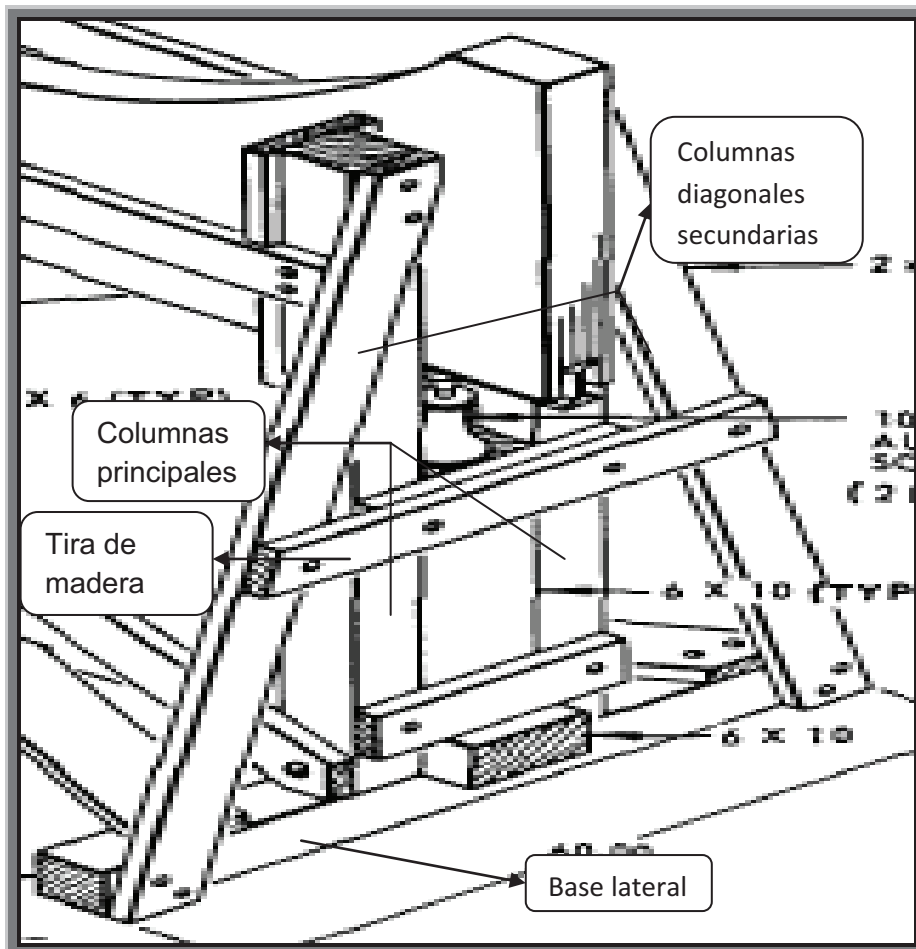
Ensamblaje de columnas diagonales secundarias
